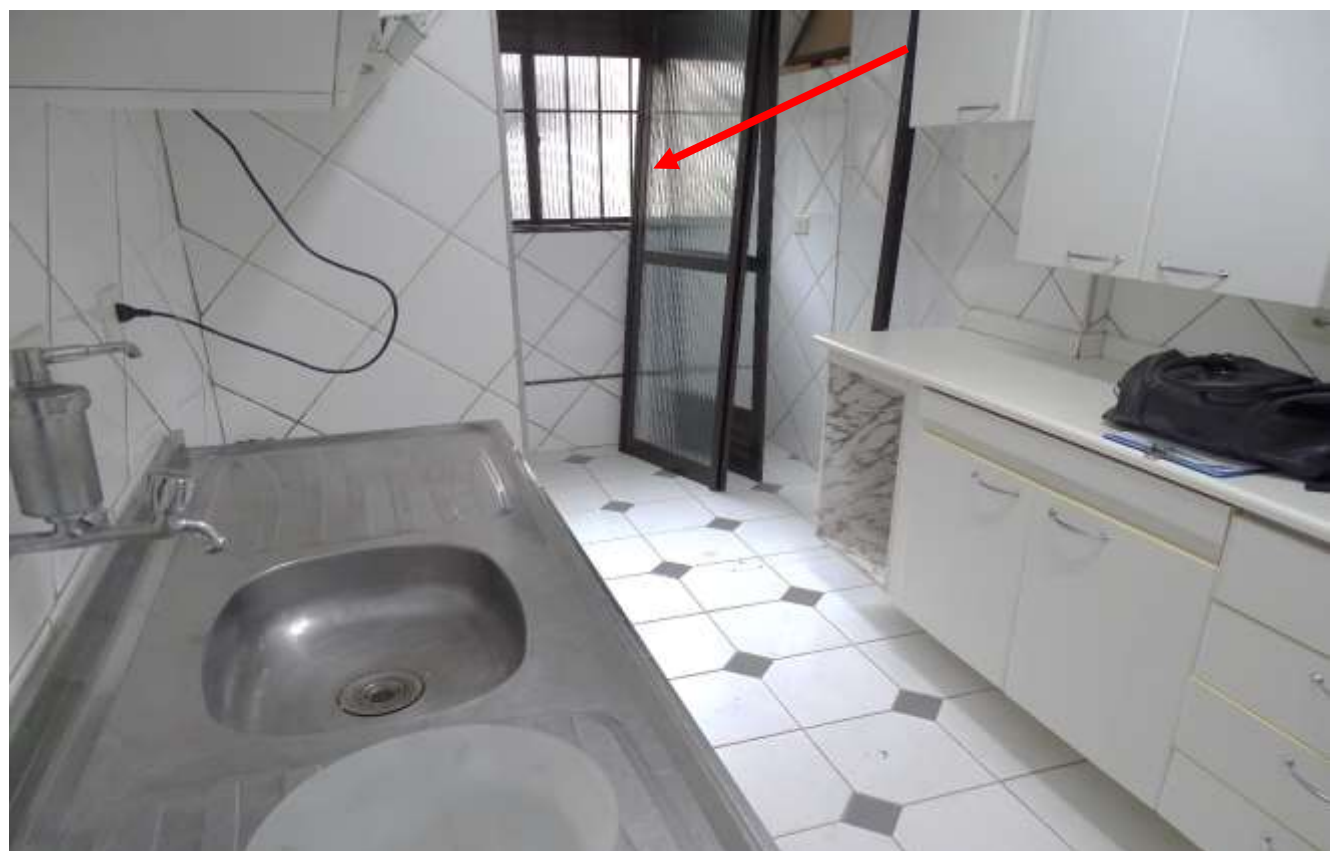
e 10 – VISTA DA VARANDA
